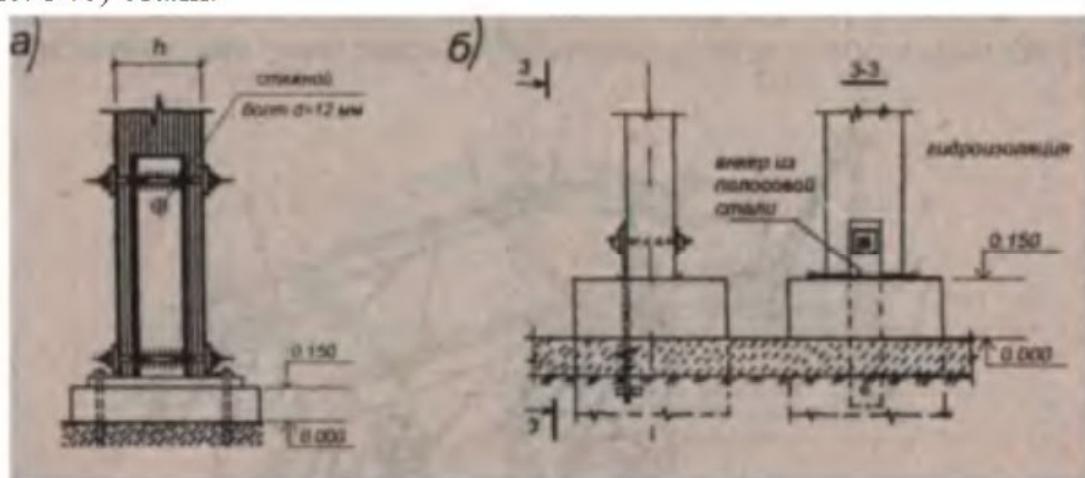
Узел жесткого (а) и шарнирного (б) крепления деревянной стойки (колонны) к фундаментам
